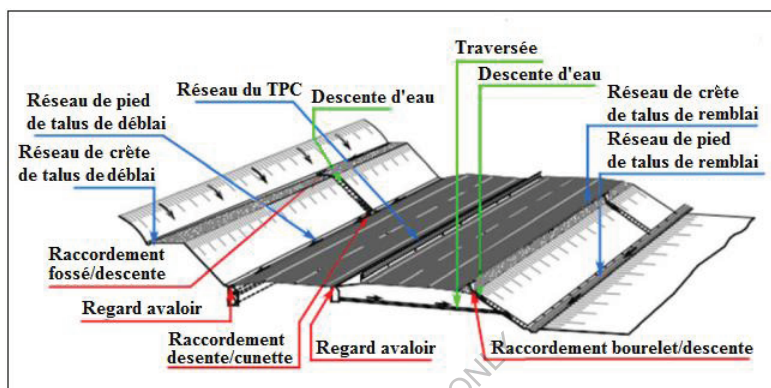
Elément d'assainissement de la plate forme d'une chaussée routière.
